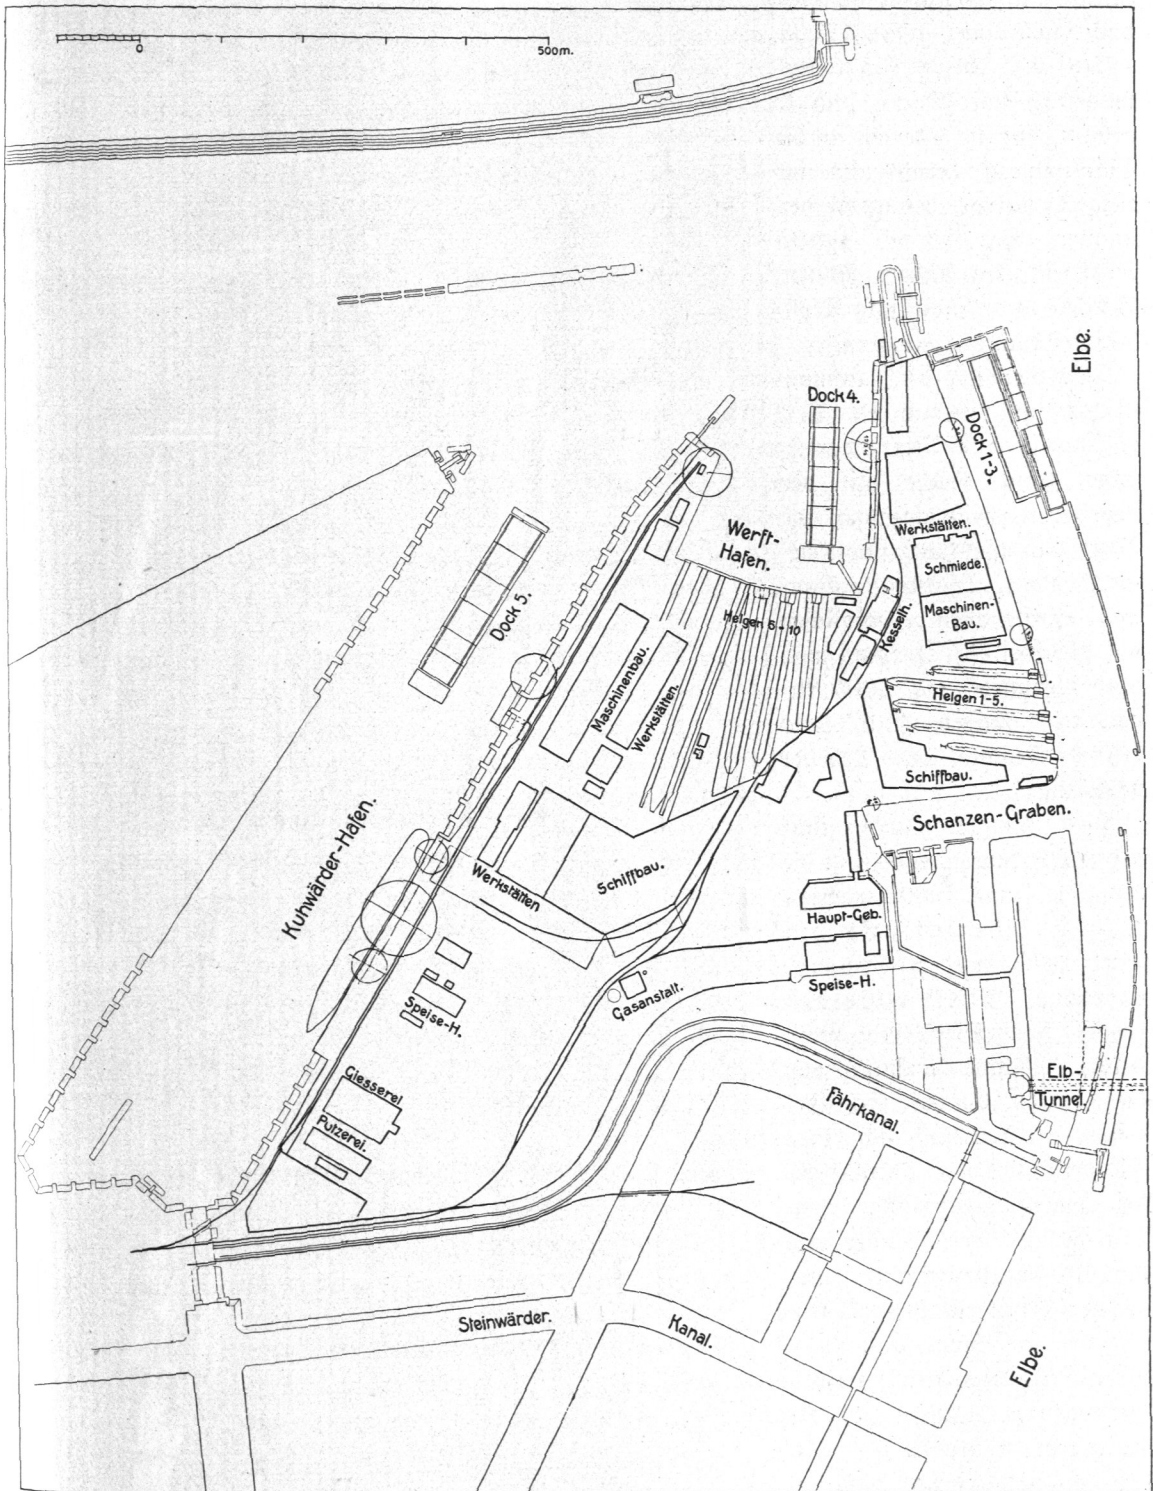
Schiffswerft und Maschinenfabrik von Blohm & Voß, Lageplan.
